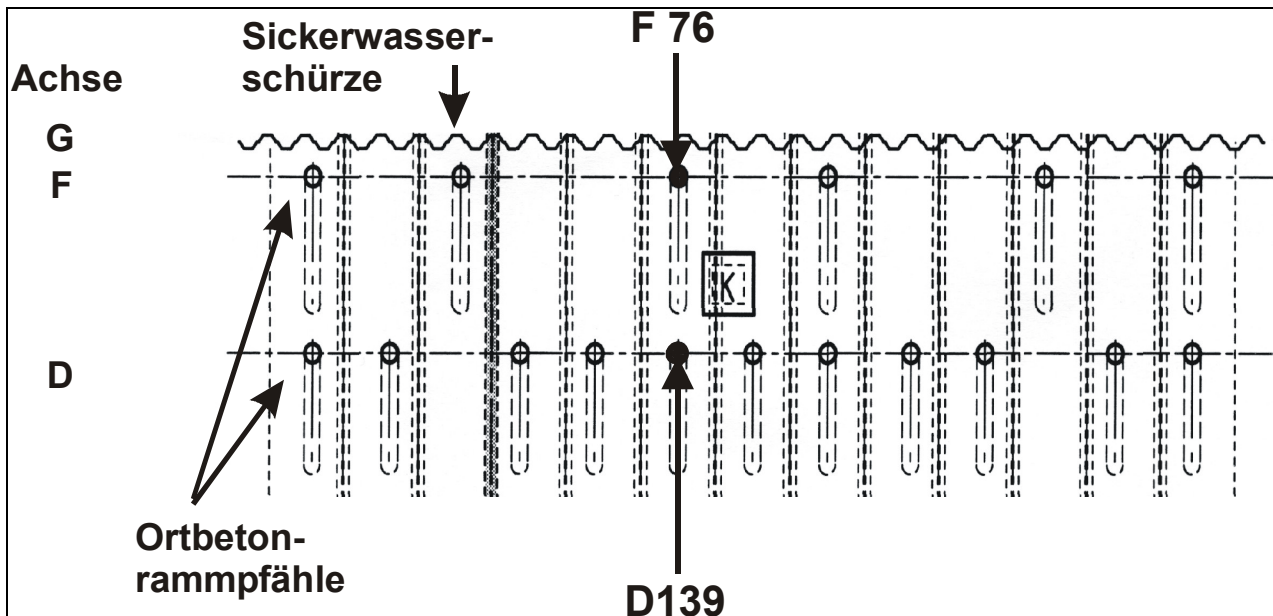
Lageplan der Messstellen D 139 und F 76 im Block 46 für Gleitmikrometer- und Inklinometermessungen
